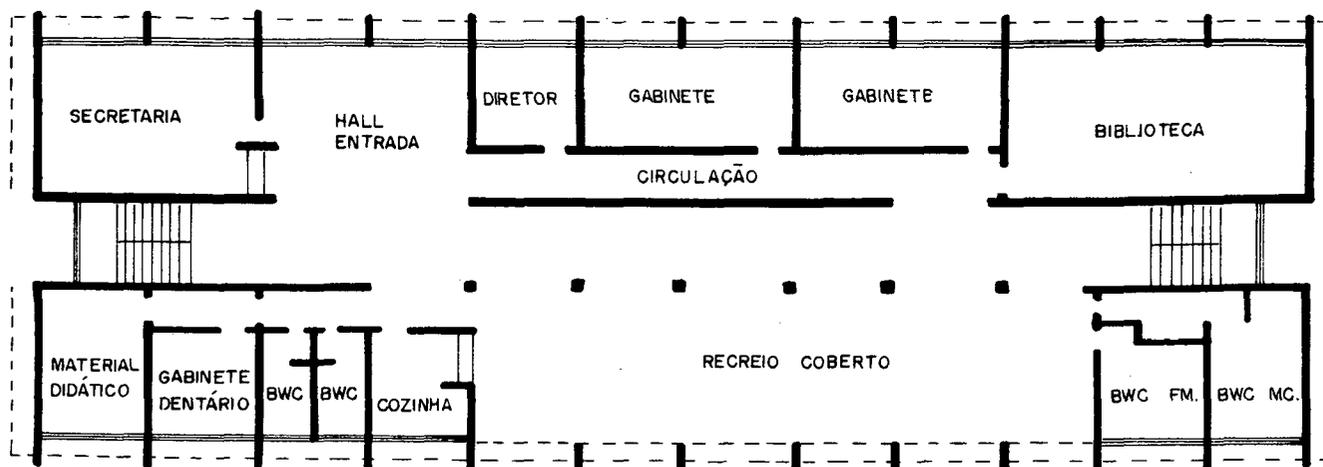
Planta baixa, pavimento inferior do Colégio Estadual Padre Anchieta. Florianópolis.
